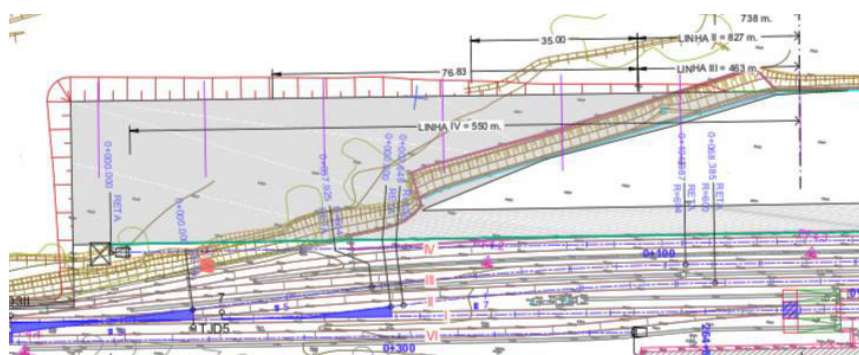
Planta Geral / Escavação - Pk 264+447 ao Pk 264+620 [38]
